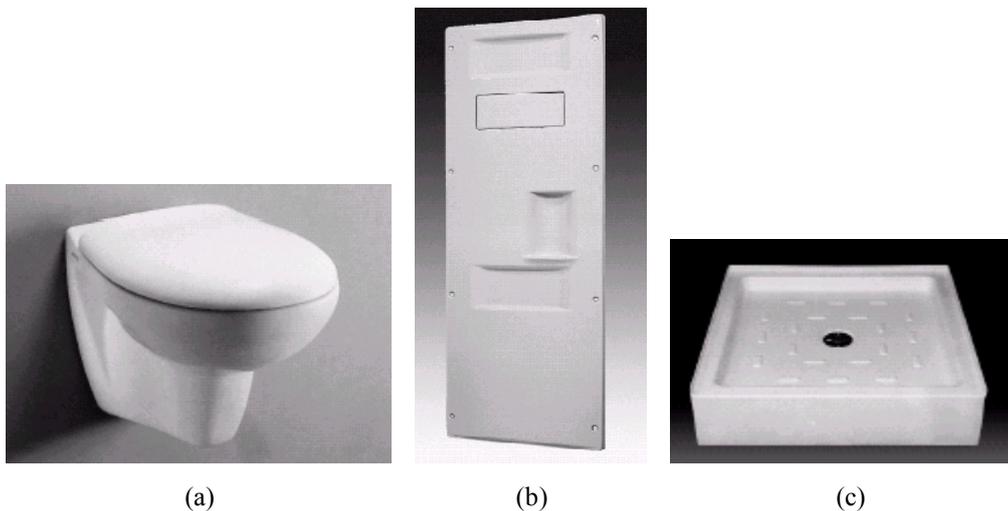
Acessórios utilizados no banheiro racional: (a) bacia sanitária de saída horizontal; (b) painel de fechamento para *shaft* visitável; e (c) piso box elevado pré-fabricado
